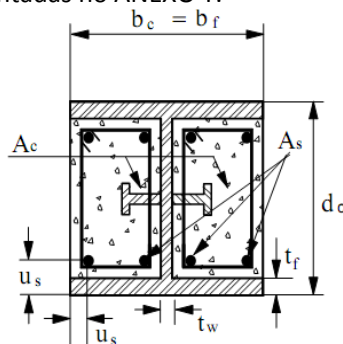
Seção transversal de pilar misto parcialmente envolvido por concreto
